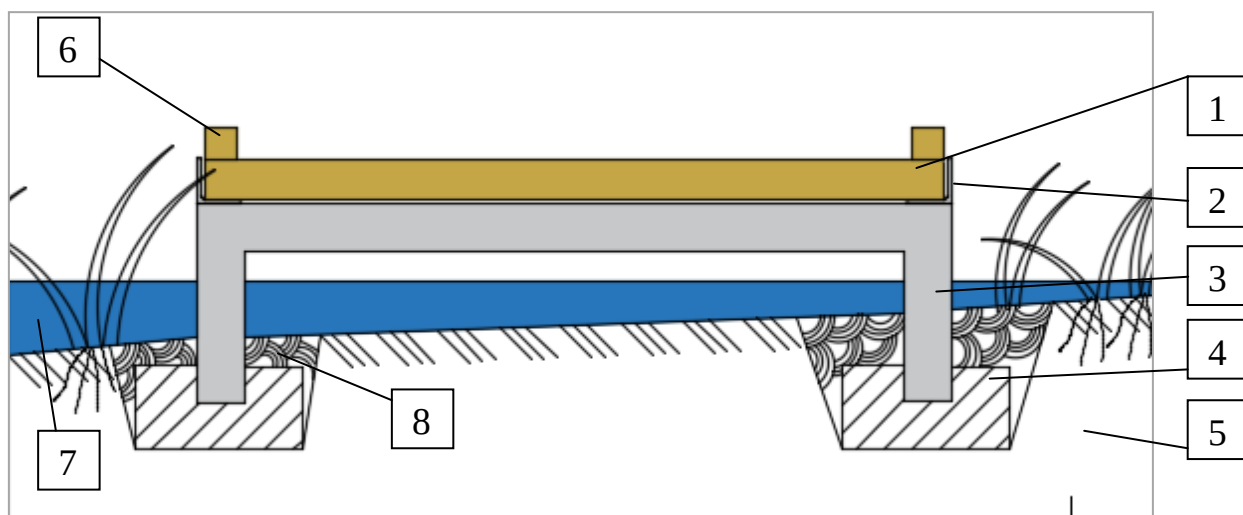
Пешеходная дорожка-мост в разрезе: 1 - плита натурального камня, 2-стальной угловой профиль, 3 – стальной прямоугольный профиль, 4 – бетонная подушка, 5 – грунт, 6- бортики для тактильного обнаружения дорожки, 7- дождевая вода, 8 – глиняный замок.
